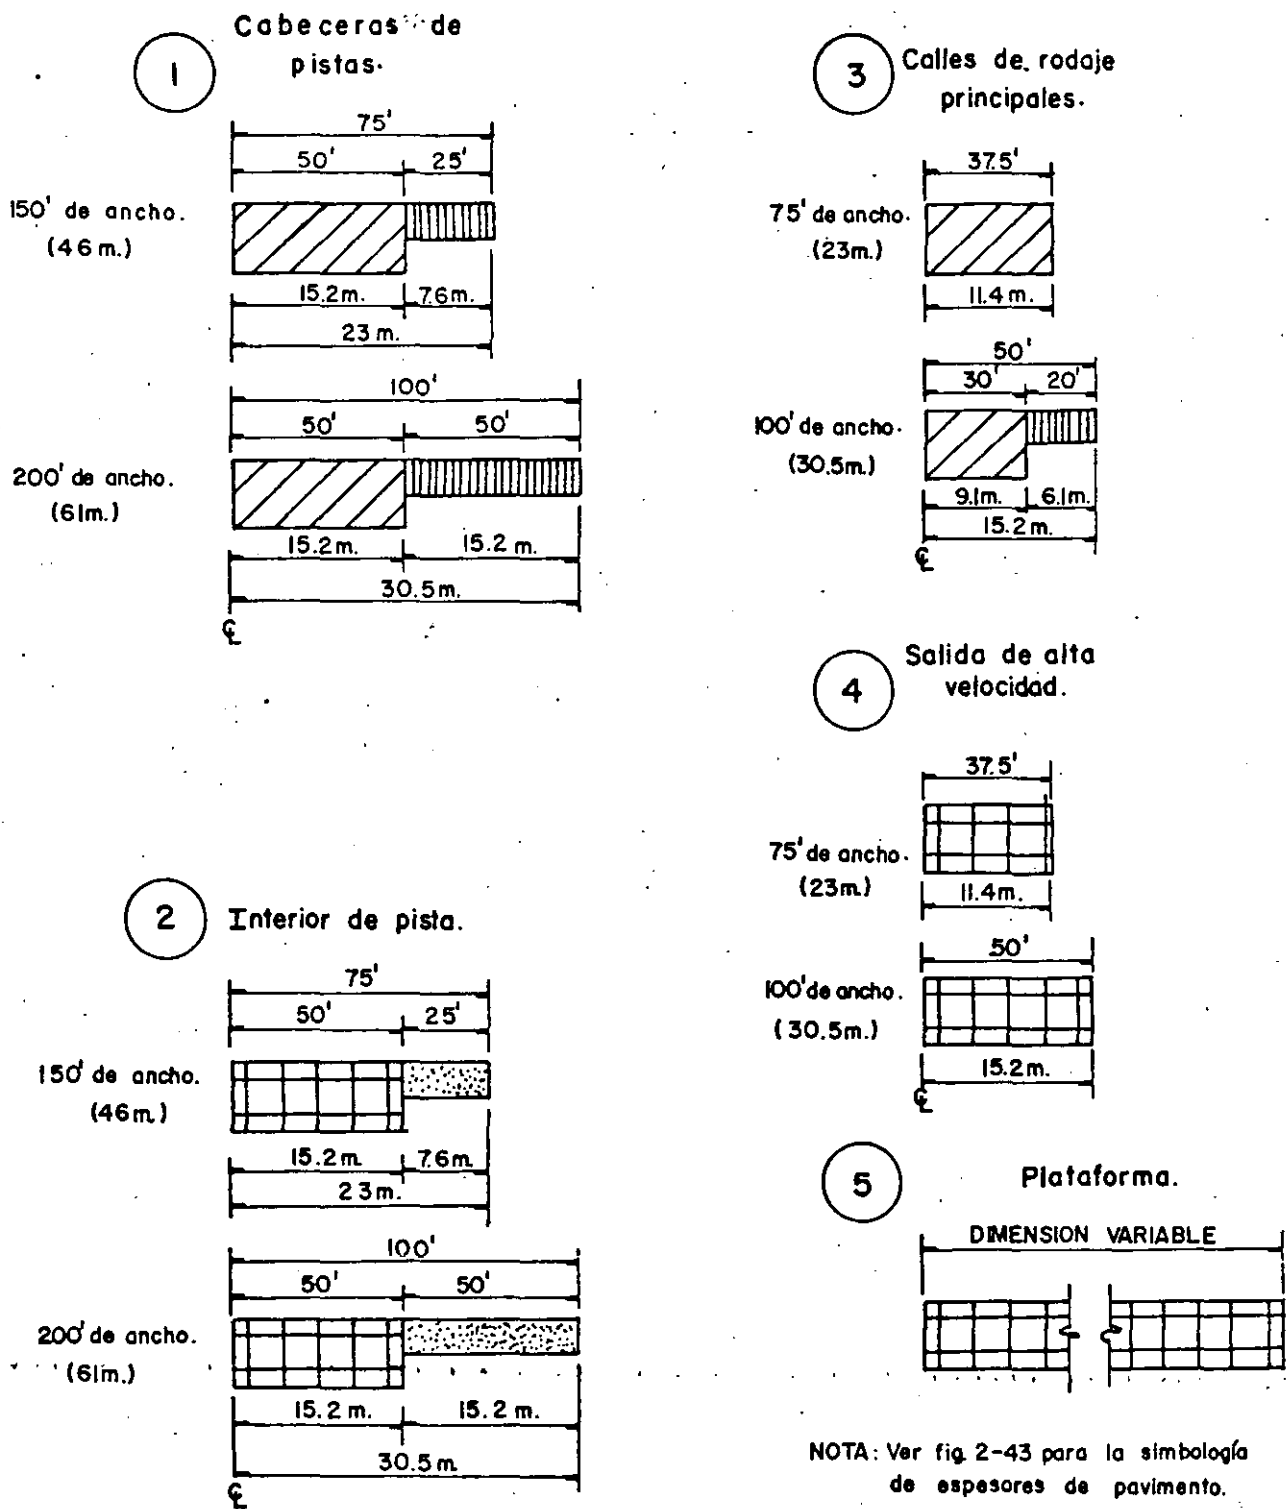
Secciones transversales de pavimento. (Instituto del asfalto 1973)
